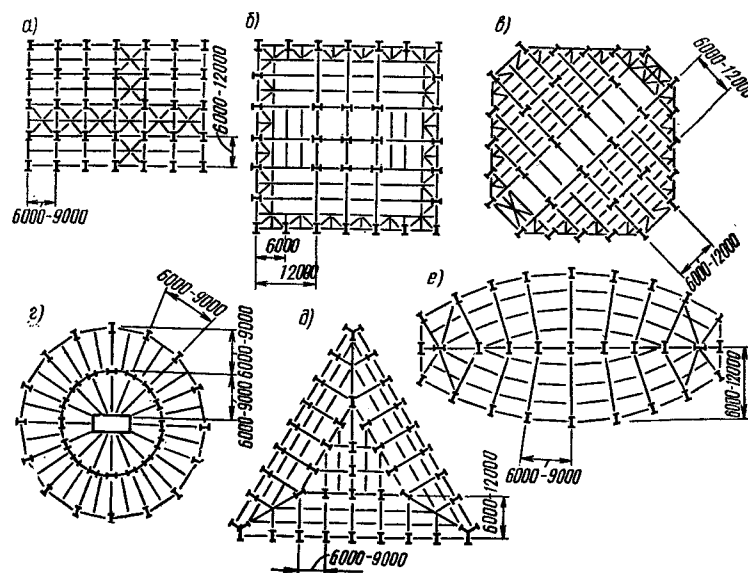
Примеры компоновочных схем междуэтажных перекрытий при различных формах плана здания (а-е)
